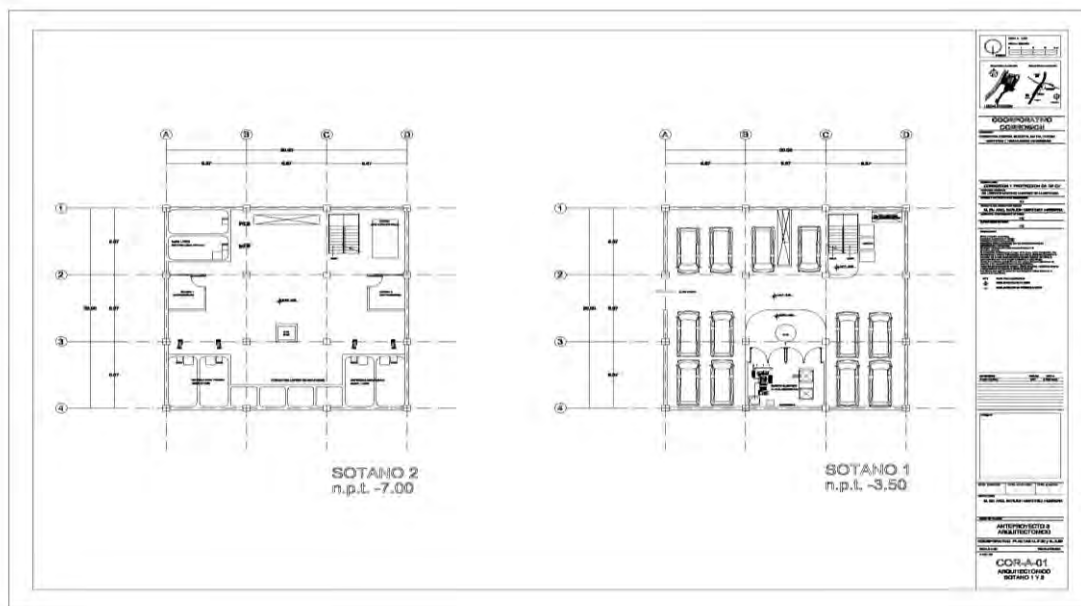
Plano arquitectónico sótano 1 y 2, fuente Baruch Martínez.
